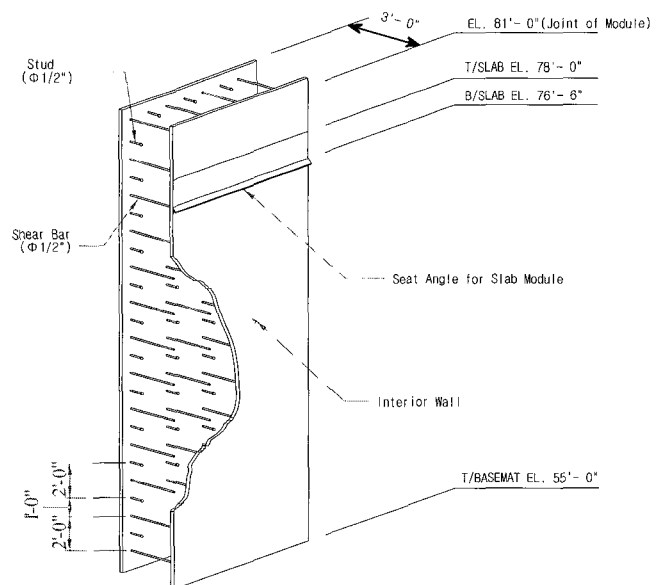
SC(Concrete Filled Steel Structure) 구조의 개념
